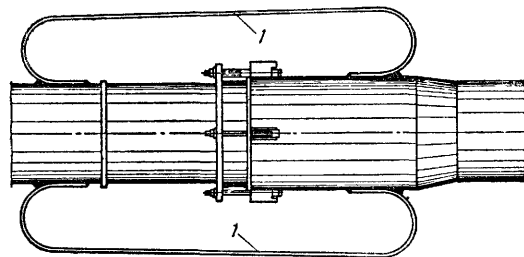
Электроперемычки на сальниковом компенсаторе
